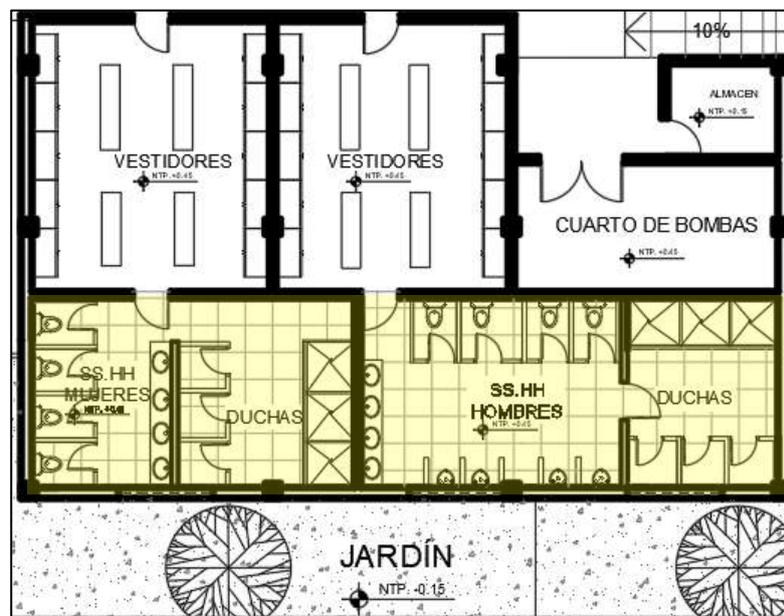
Planta primer nivel del proyecto-Servicios Generales.
